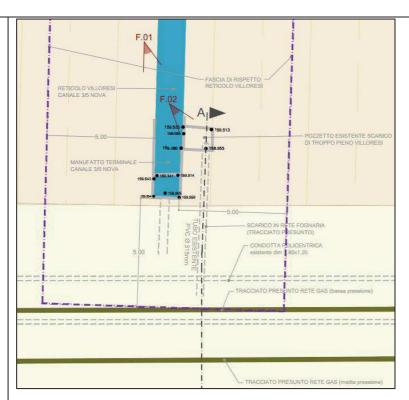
Planimetria stato di fatto nella zona del canale 3/5 di Nova
